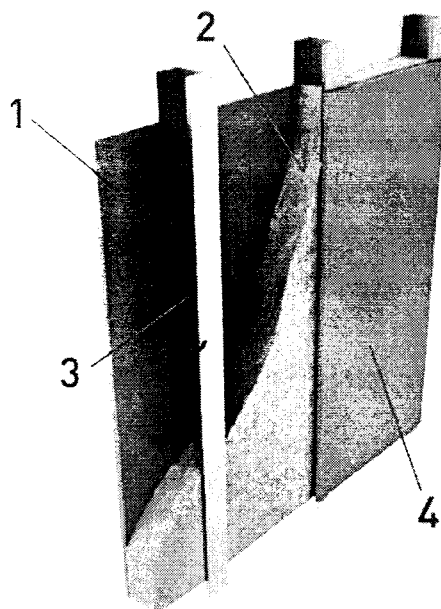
Утепленная перегородка: 1, 4 – листы из гипсокартона, 2 – тепловая изоляция, 3 – каркас из металлического профиля
